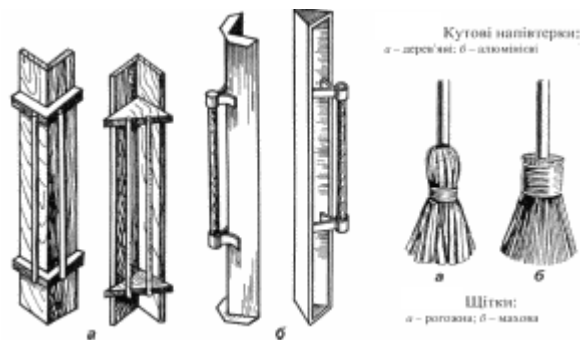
Інструменти для розрівнювання й оброблення нанесеного на поверхню штукатурного шару:
